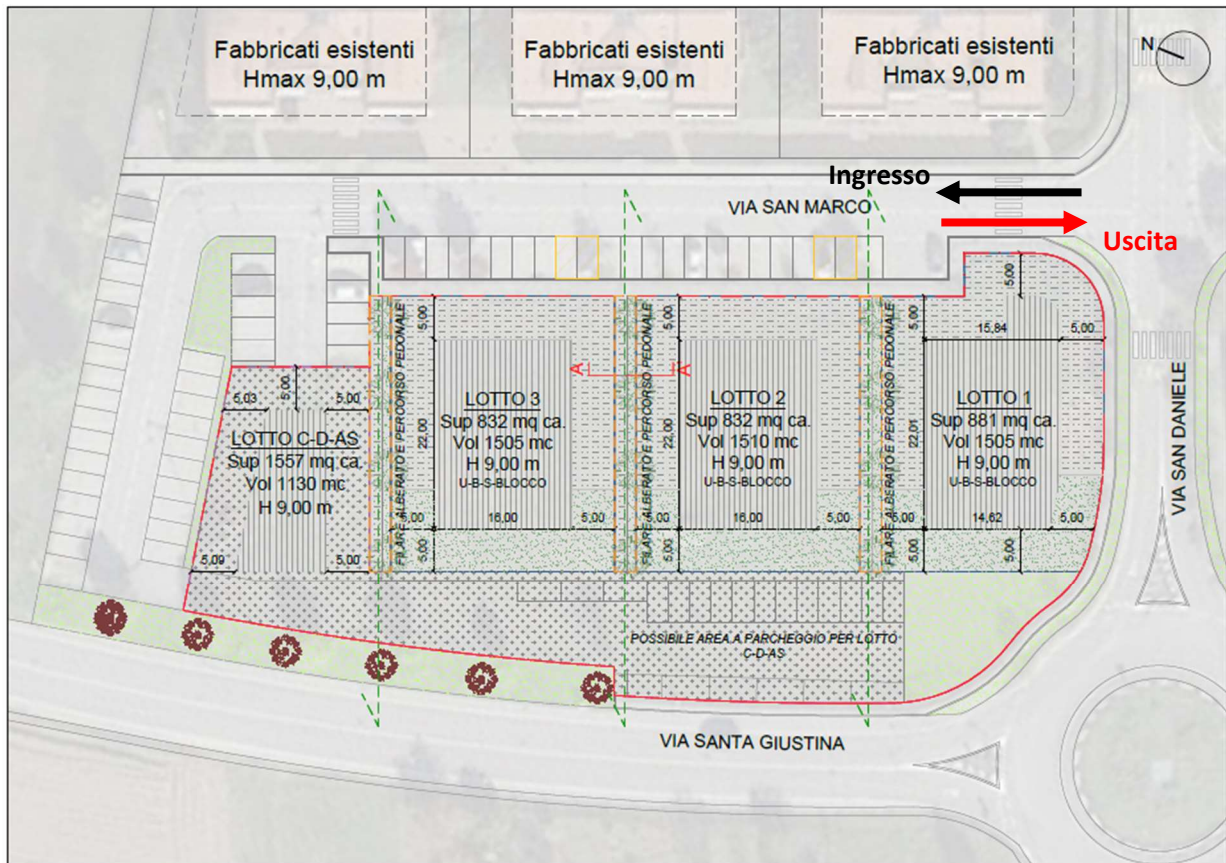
Stralcio planimetria ambito di studio. Accessi.
